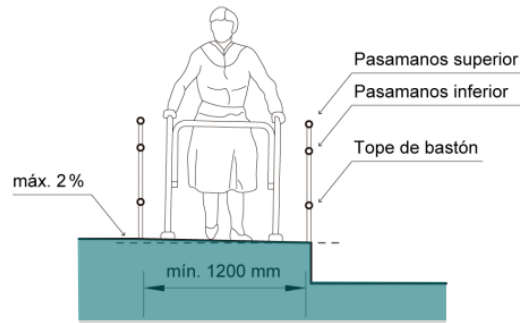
Pendiente transversal y ancho mínimo de rampa. Fuente: (INEN, 2016)
